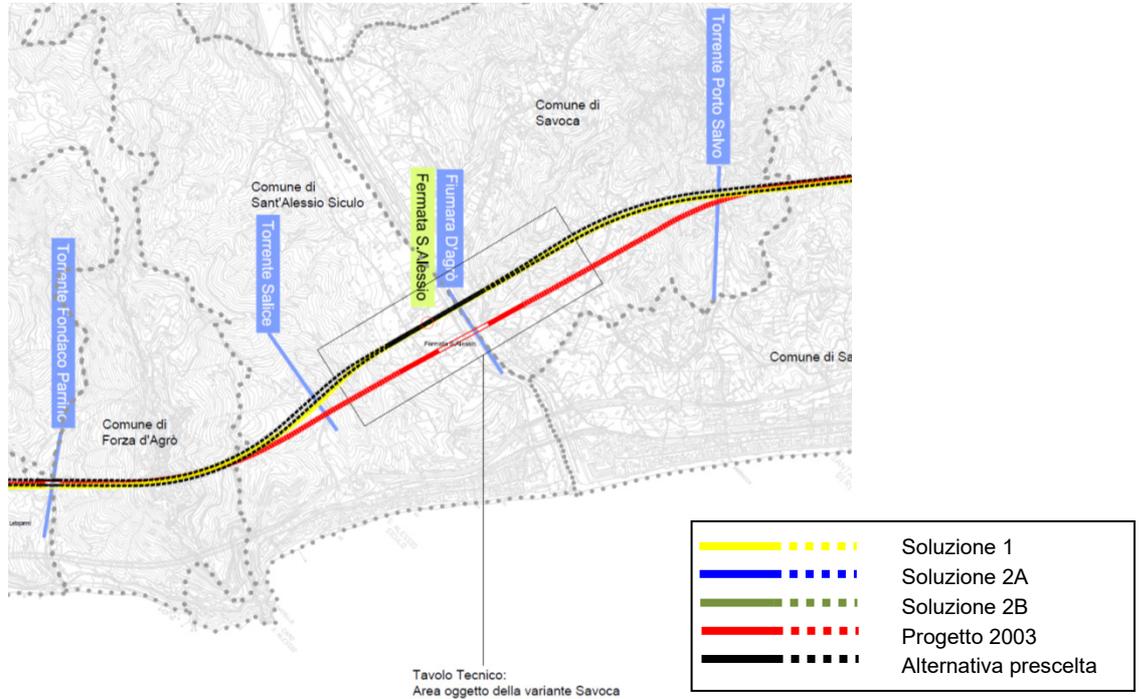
Tavolo Tecnico Variante planimetrica S. Alessio S. – Savoca
